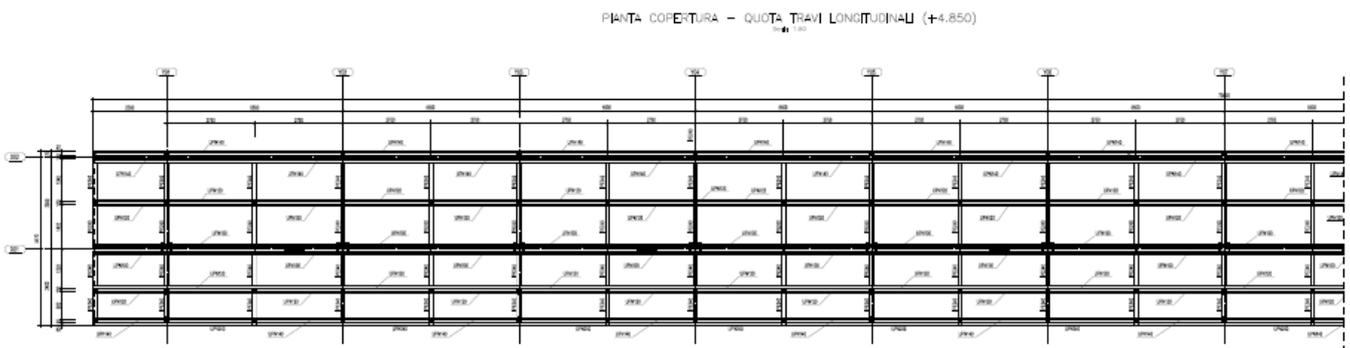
Pensiline – Stralcio Pianta Copertura quota +4.850 - Pensilina Sud
